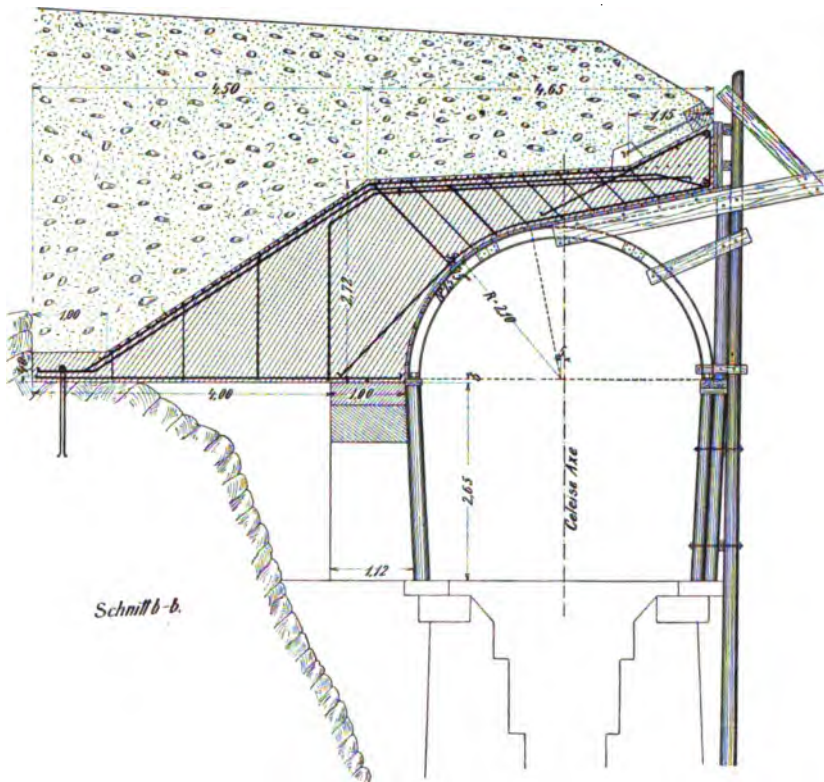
Armierungsplan und Einrüstung der Schutzvorrichtung gegen Steinschlag in km 52,1 der rhätischen Bahn.
